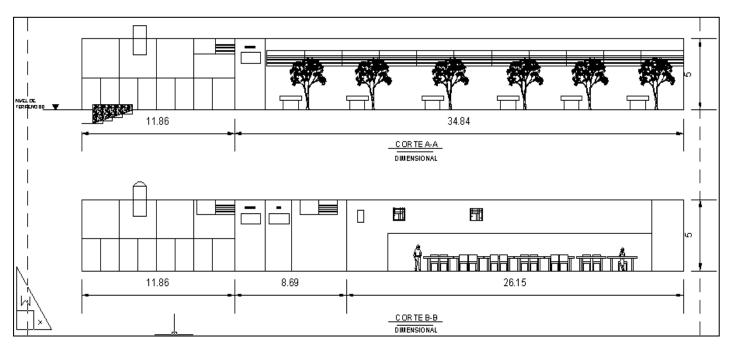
Corte A-A y corte B-B de la zona de estudio para la planta de biogás
